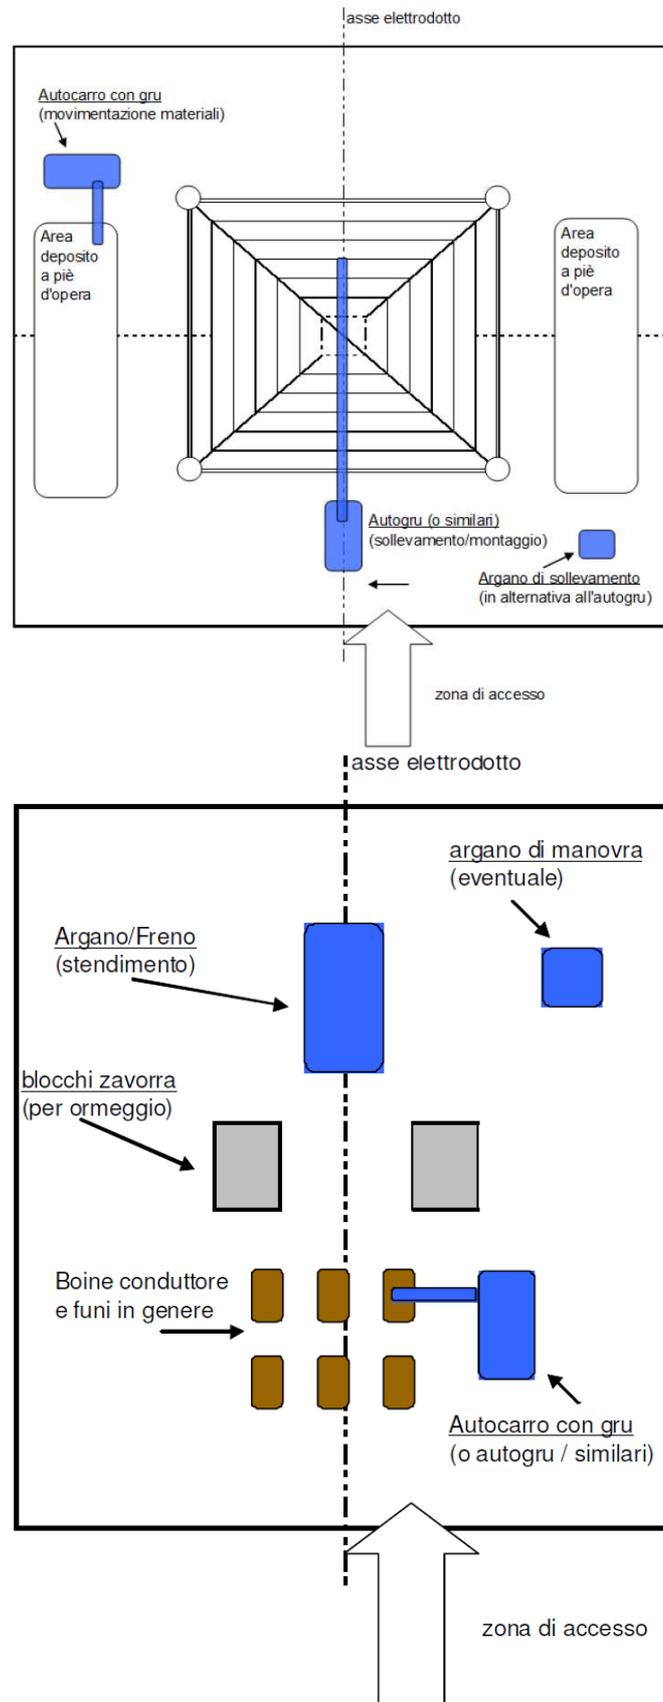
Planimetria tipologica dell'area di cantiere per il montaggio del sostegno
